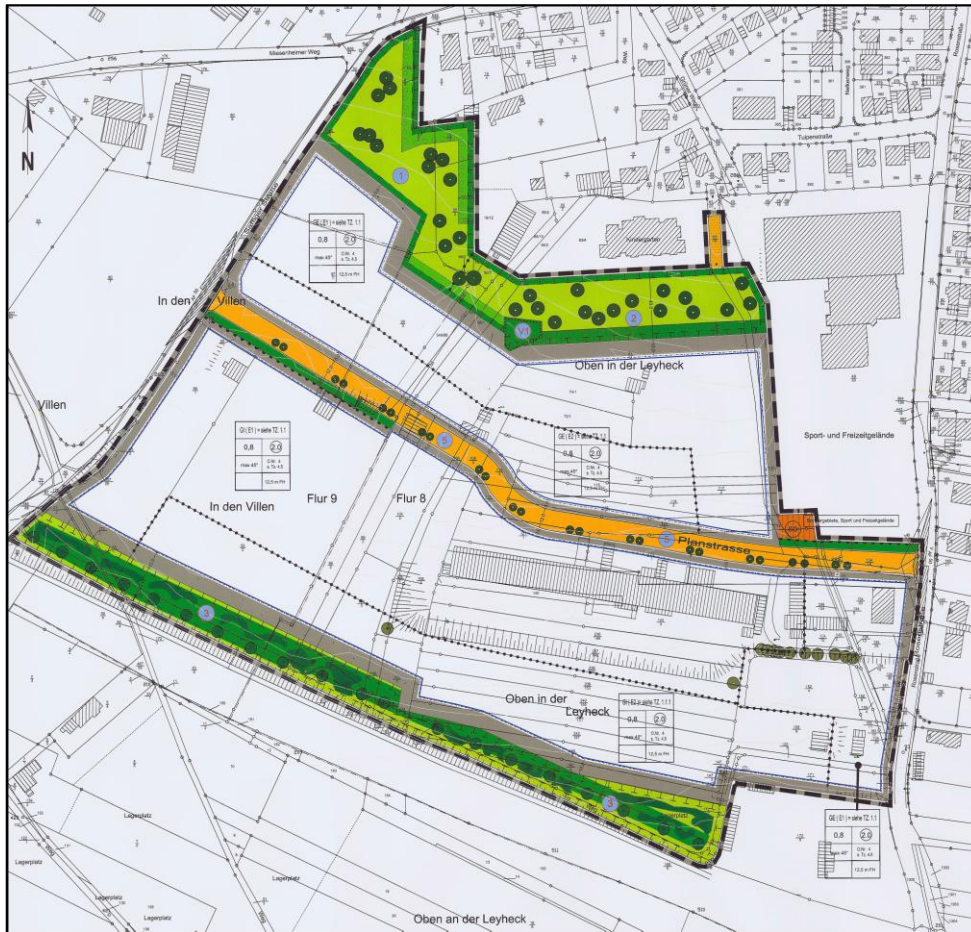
Auszug aus dem Bebauungsplan "Zwischen Rosenstraße und Saffiger Straße"
